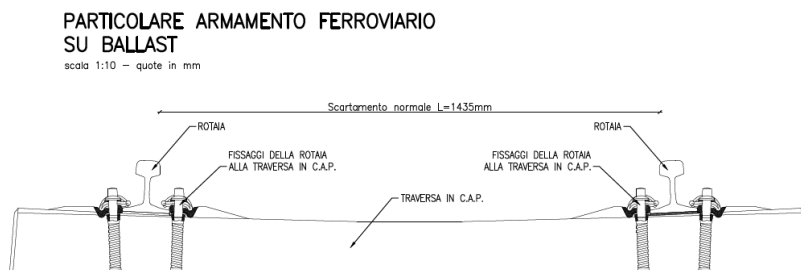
Estratto della tavola Sezioni Tipologiche: Armamento ferroviario asta di raccordo
